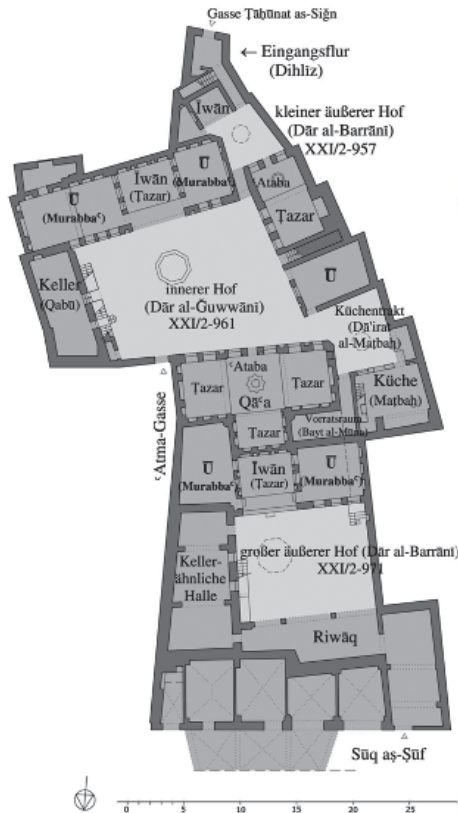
Bayt al-Hawraniya, Grundriss EG
